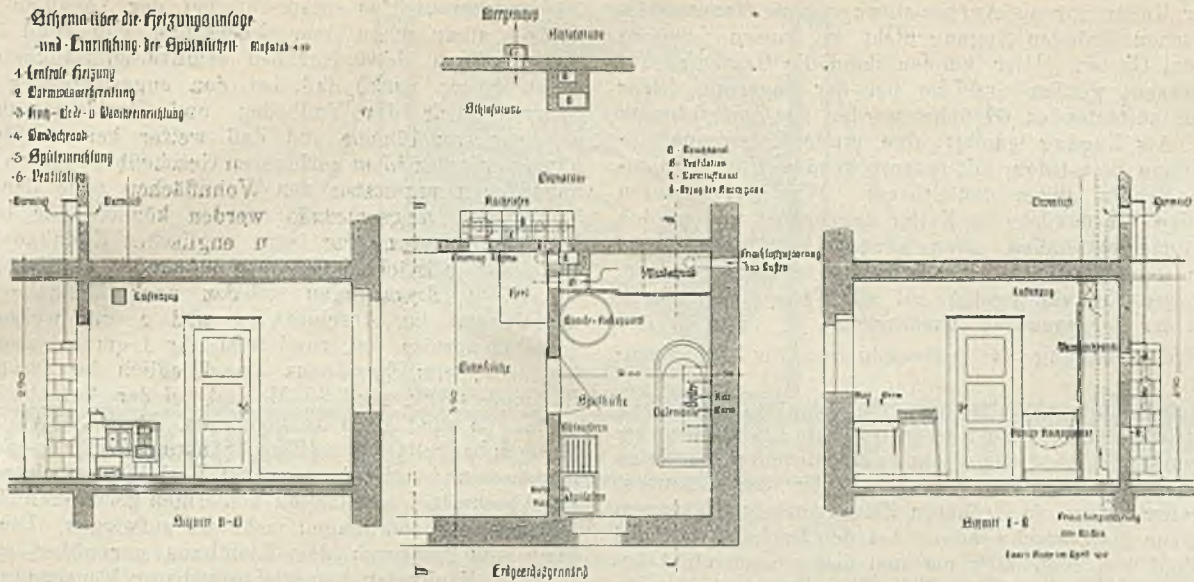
bis 494 Spülküchenanlage in den Gebäuden der Gartenstadt Margarethenhöhe
